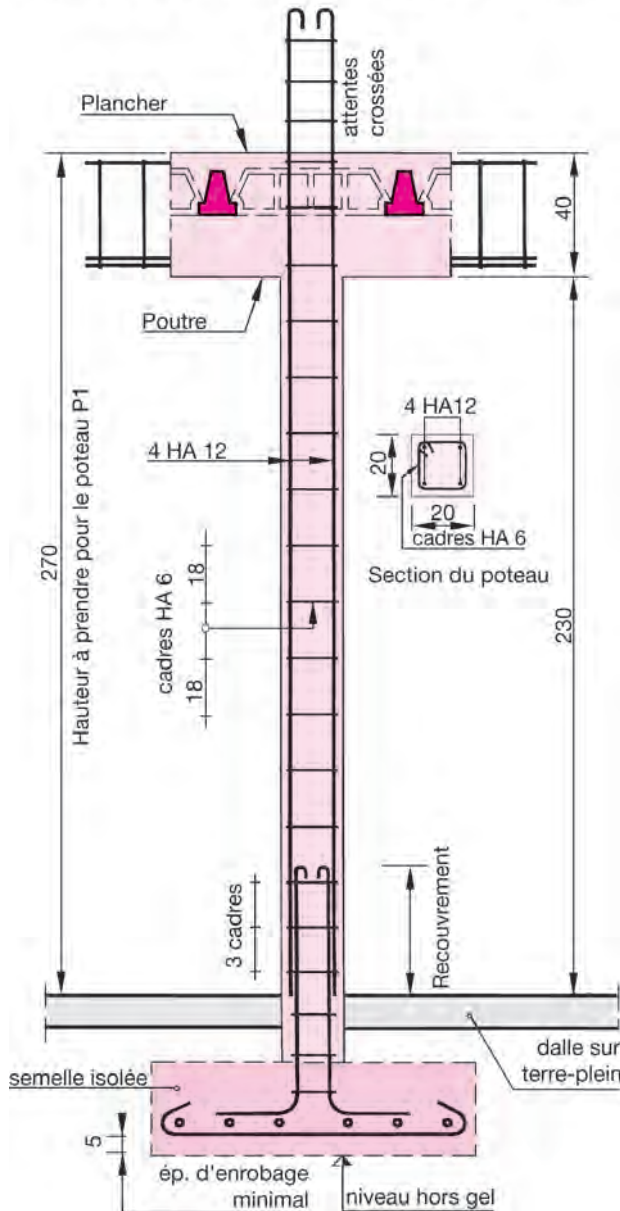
Ouvrage en béton armé pour porter un plancher
